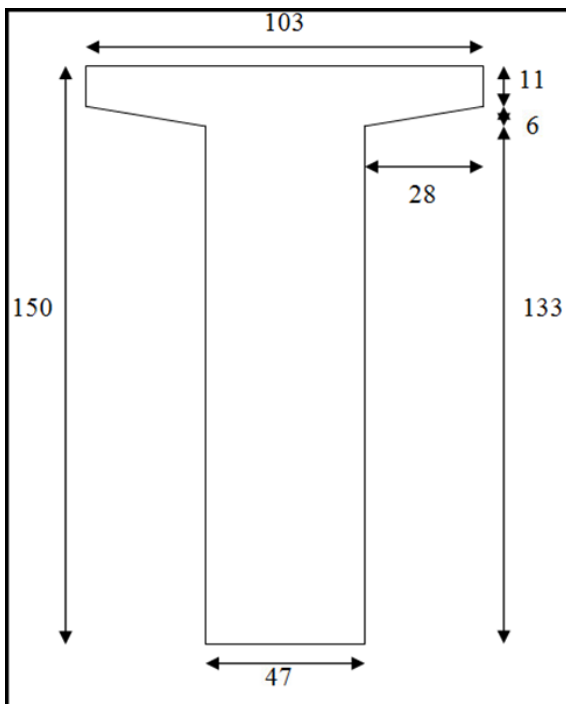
Coupe A-A: Section de la poutre en « T » Sans hourdis à l'about poutre
